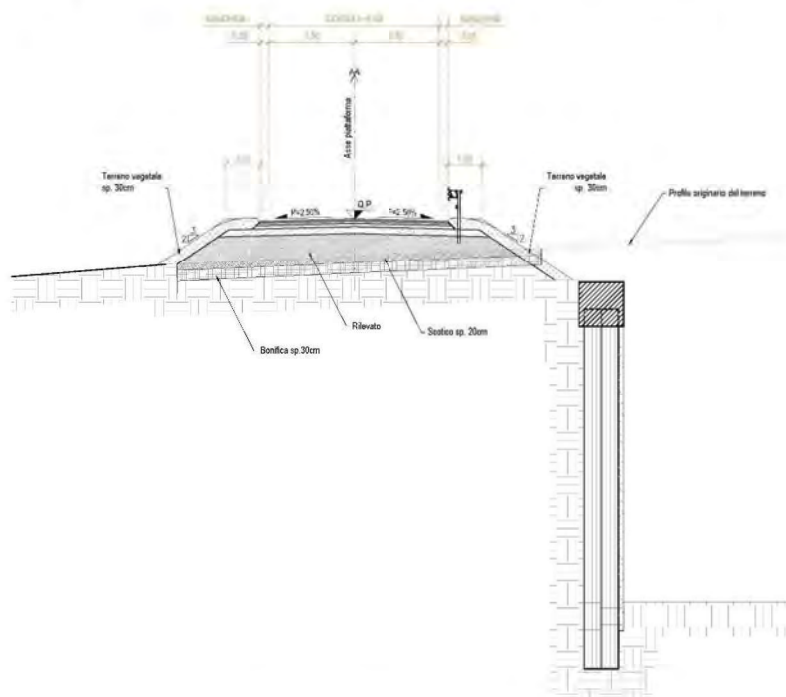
Sezione viabilità di accesso. Opere di contenimento del terreno.
